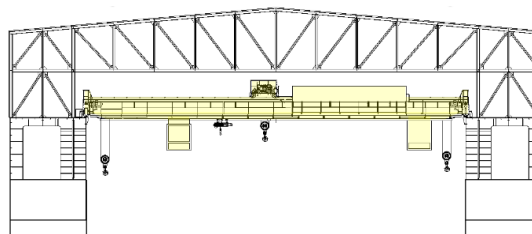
Неразрывное соединение поперечных рам крыши с башнями дока
